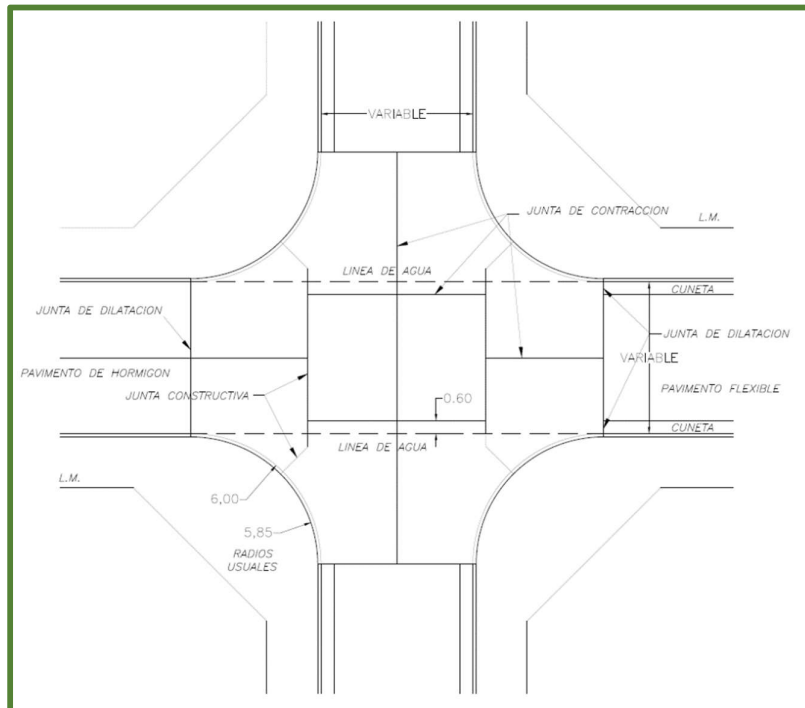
Planimetría Tipo para Bocacalles (Municipalidad de Córdoba)
